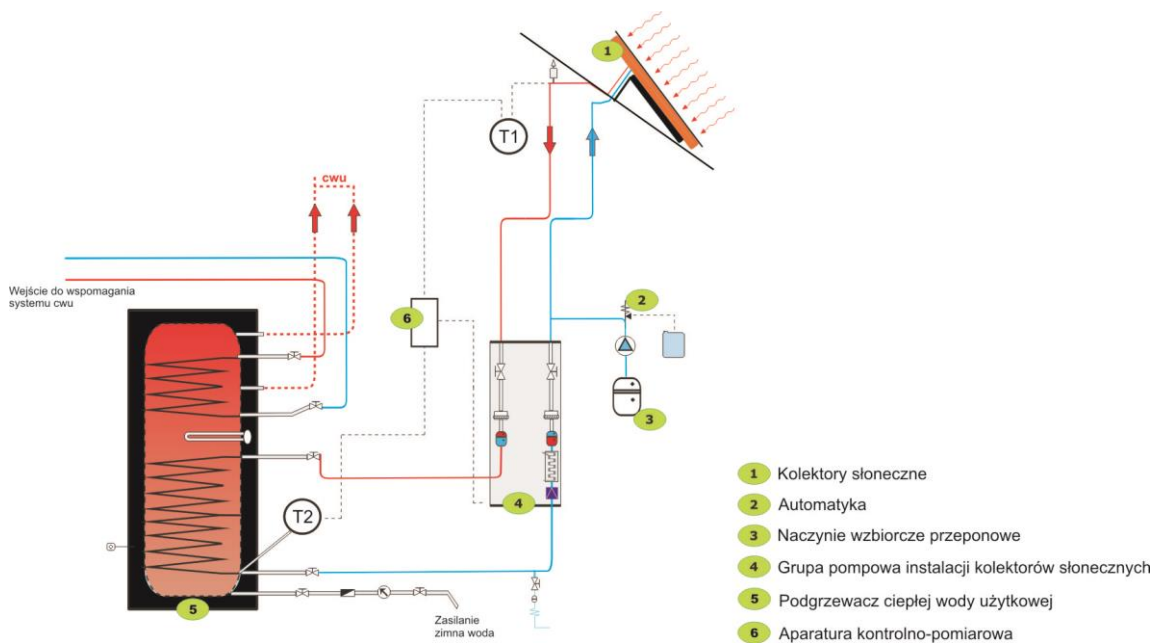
Schemat przykładowej instalacji solarnej - I grupa konstrukcyjna (montaż kolektorów słonecznych bezpośrednio na dachu)
